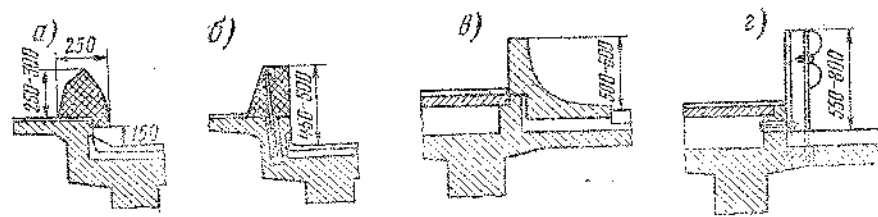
Конструкции ограждений на монолитных железобетонных мостах и металлических мостах с монолитной железобетонной плитой
